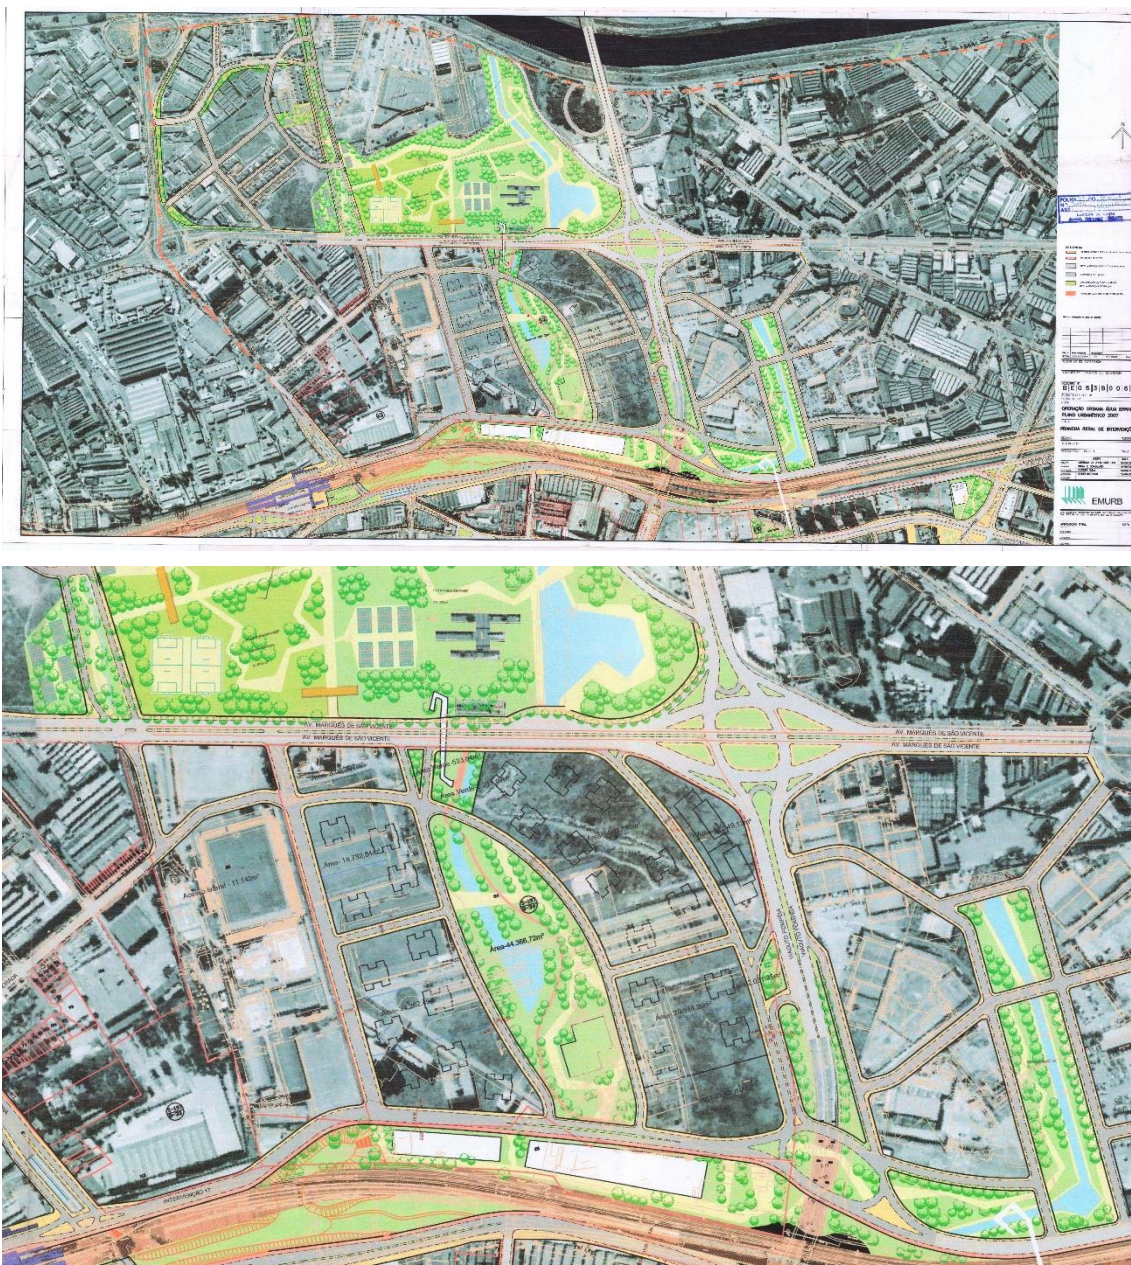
Montagem com a implantação geral do Plano Urbanístico elaborada pela EMURB em setembro de 2007, e detalhe da gleba da TELESP. Nesta versão, o parque projetado na gleba da TELESP já tem a forma muito similar à versão final do empreendimento proposto pela Tecnisa. Fonte: Processo nº 2006.0.334.740.8/fls. 80.
